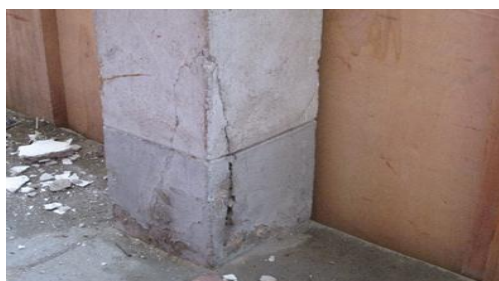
Columna fisurada. Fuente: Elaboración propia
